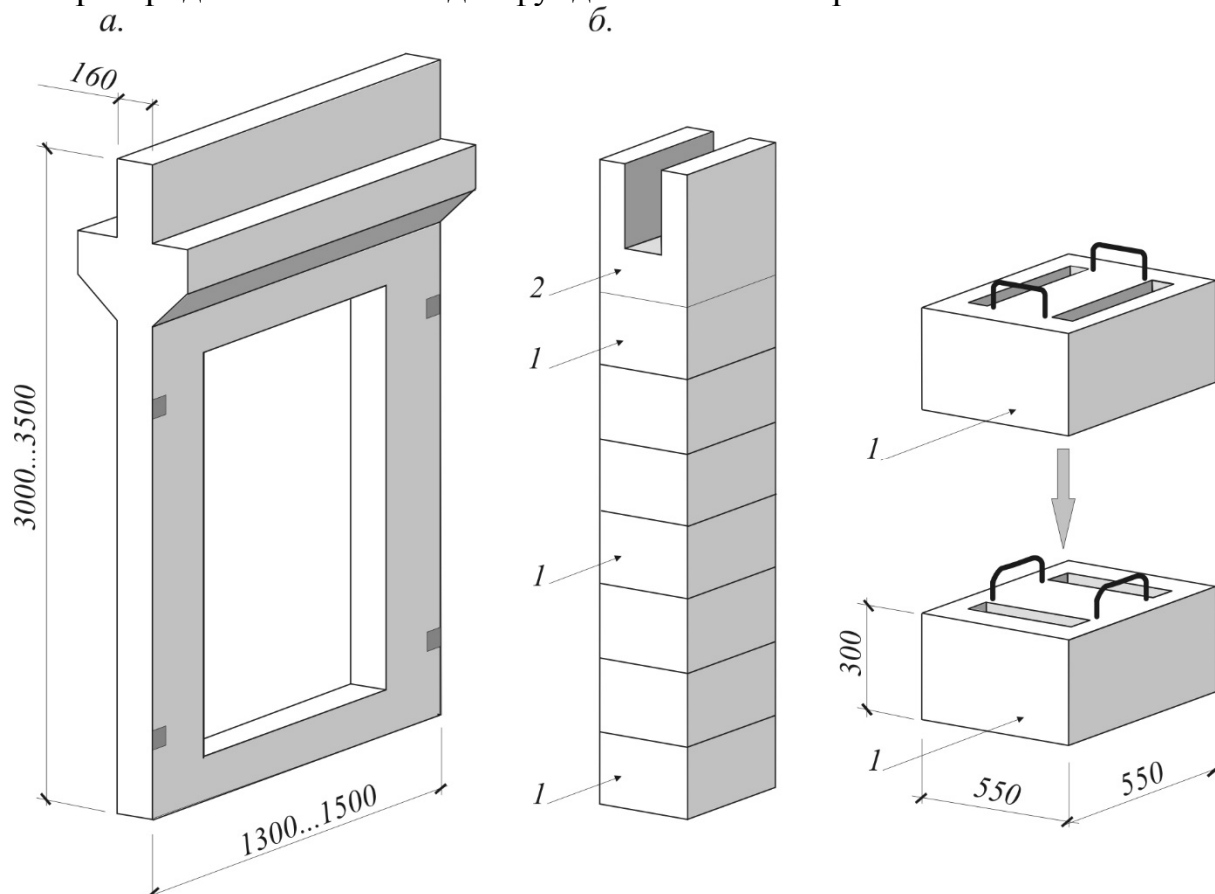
Вспомогательные конструкции, используемые при замене перекрытий:
